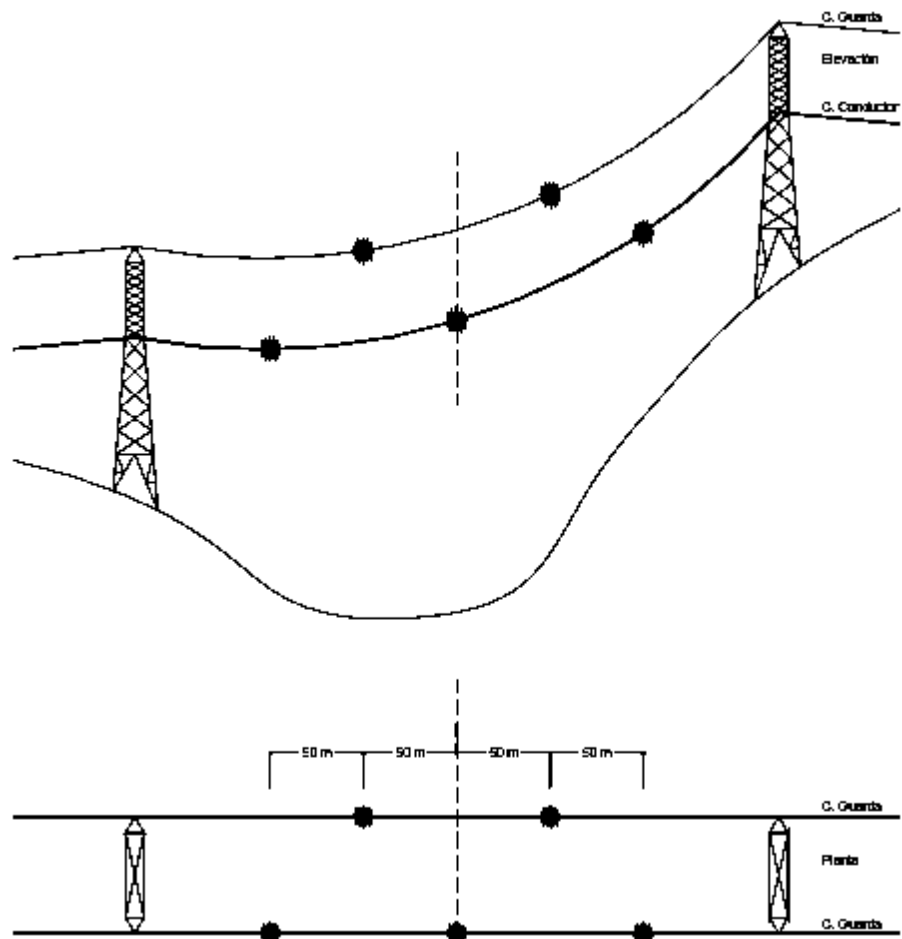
Señalamiento de estructuras en cruzamientos con barrancas profundas
